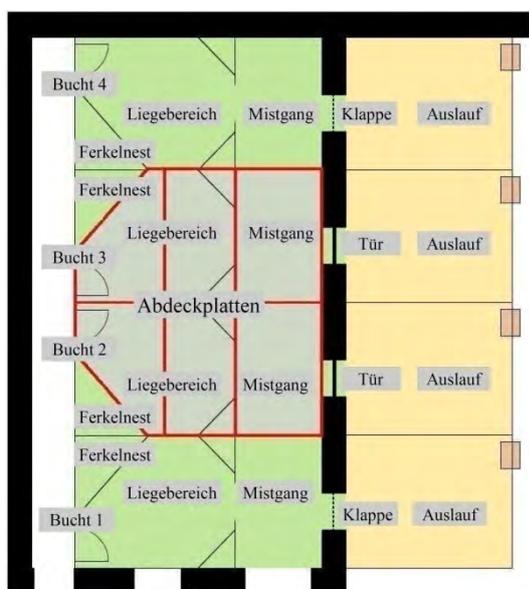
Grundrissdarstellung des 1. Versuchsaufbaus mit komplett abgedeckten Buchten
